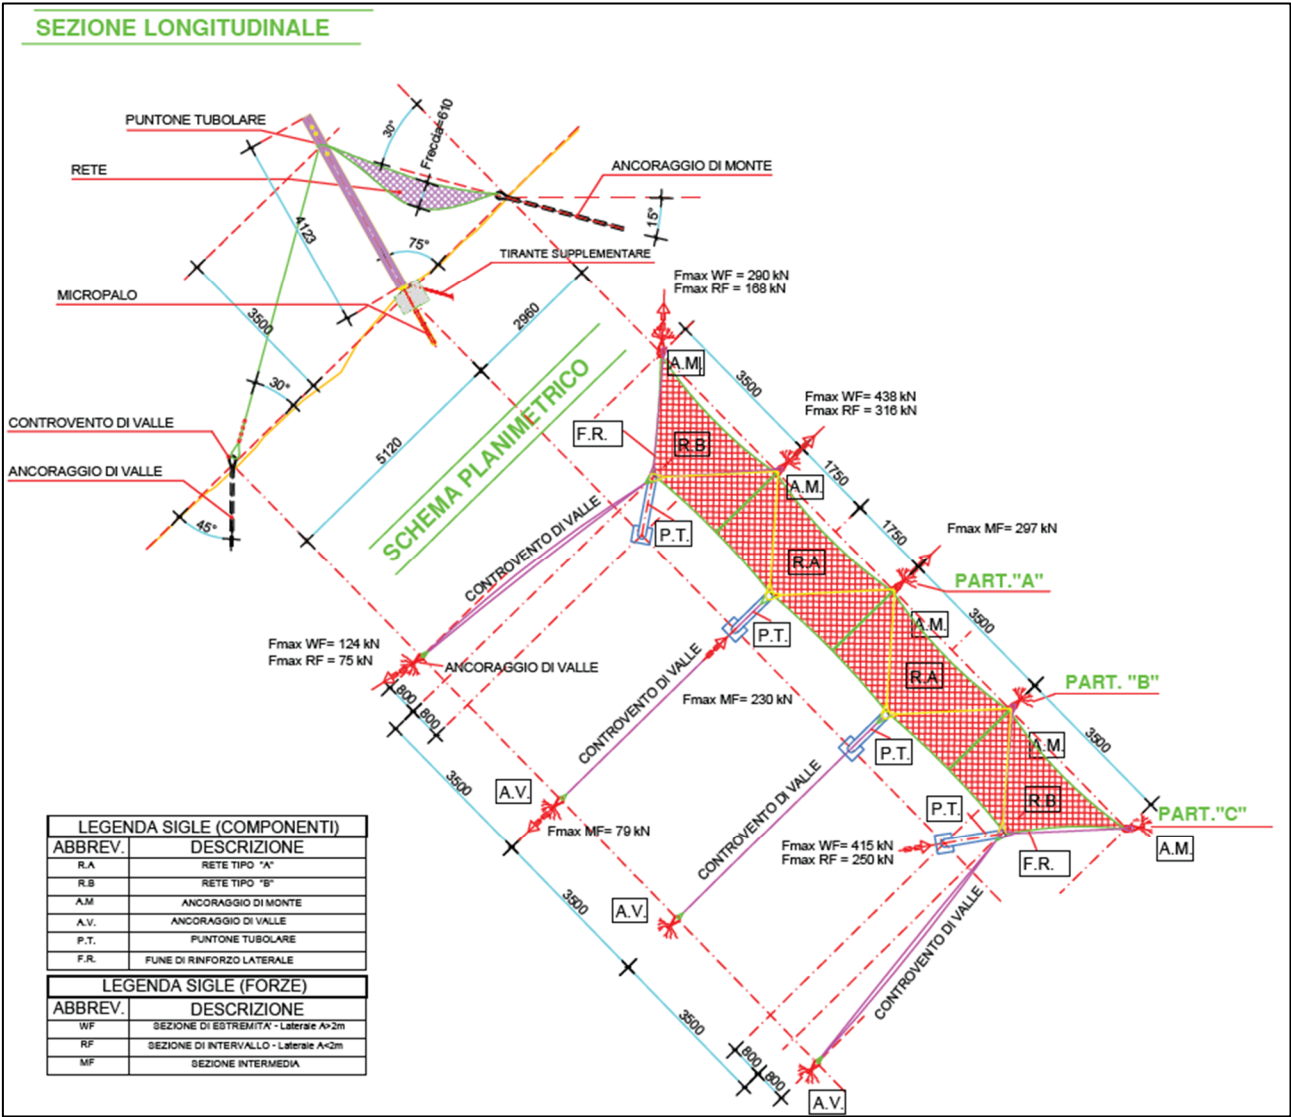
Vista in sezione e in pianta delle reti fermaneve in progetto con i carichi agenti sugli ancoraggi
